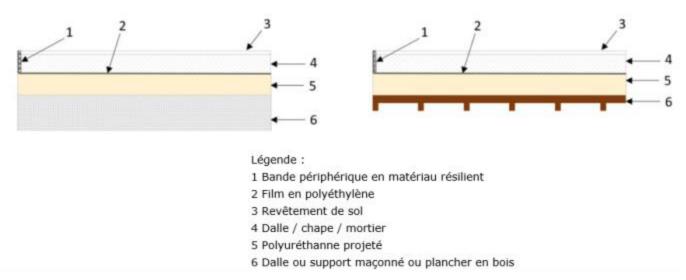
Coupe avec support béton ou maçonné et plancher bois
